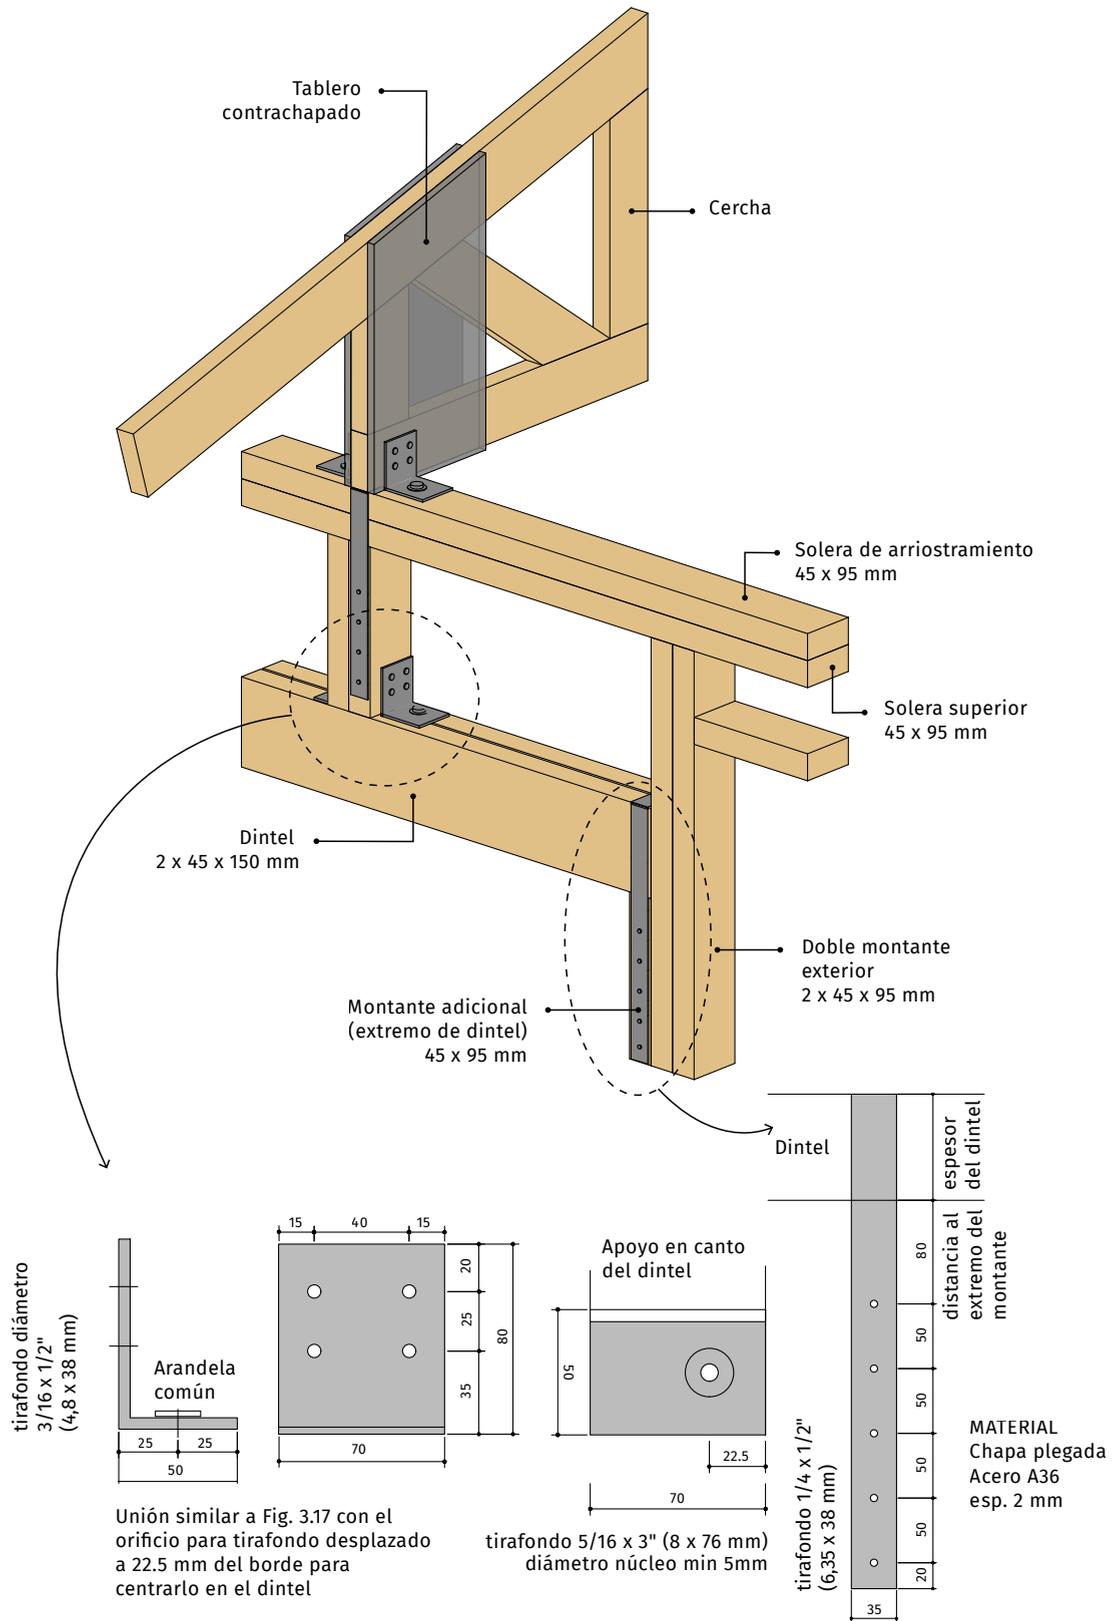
Detalle de apoyo de cercha sobre dintel
